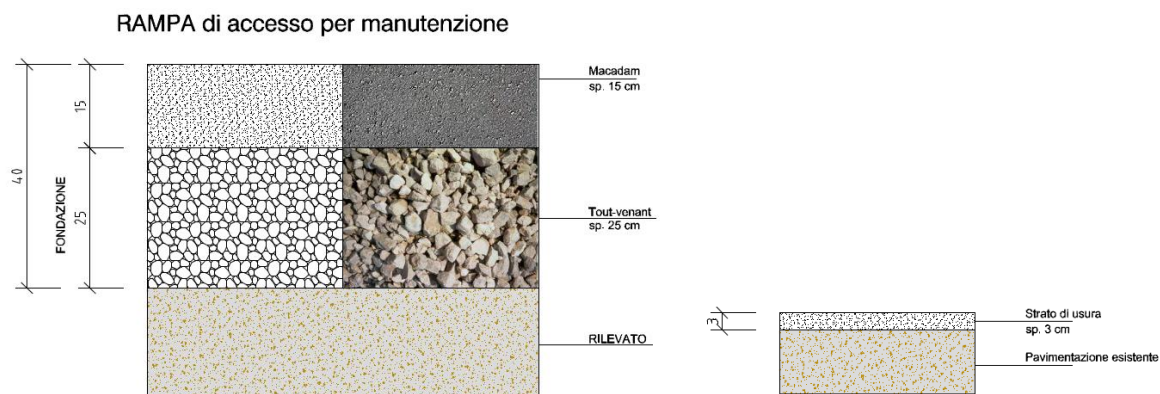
Sezione tipo rampa di servizio e pista ciclopedonale
